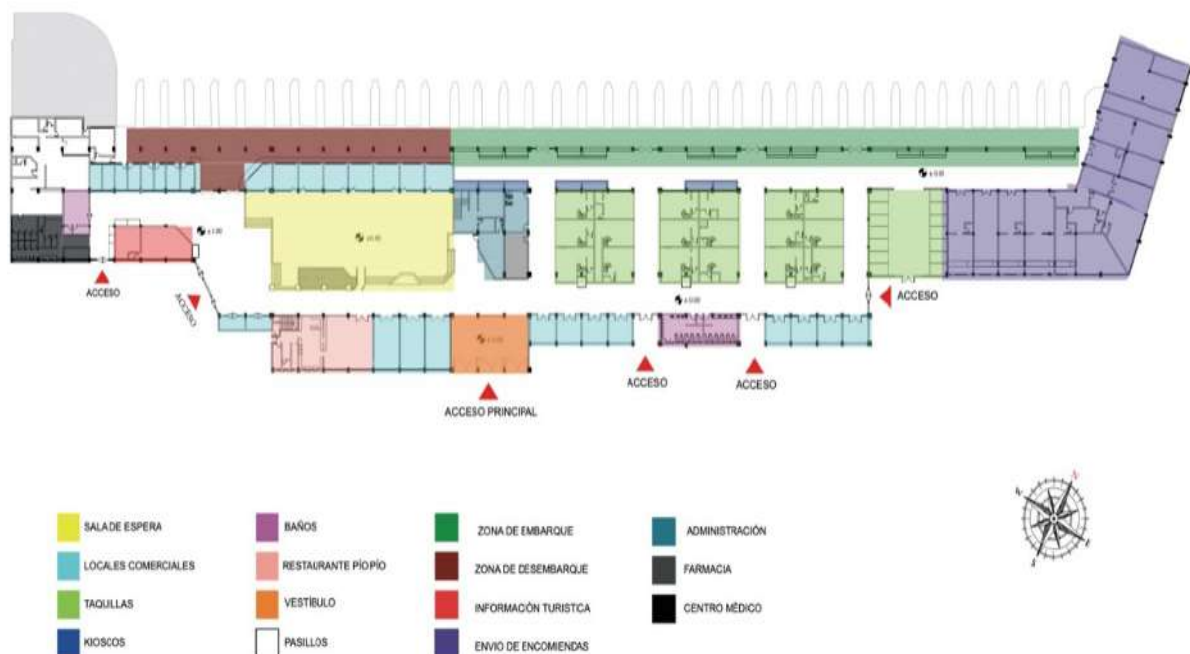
Planta zonificación Terminal terrestre Cuenca.
